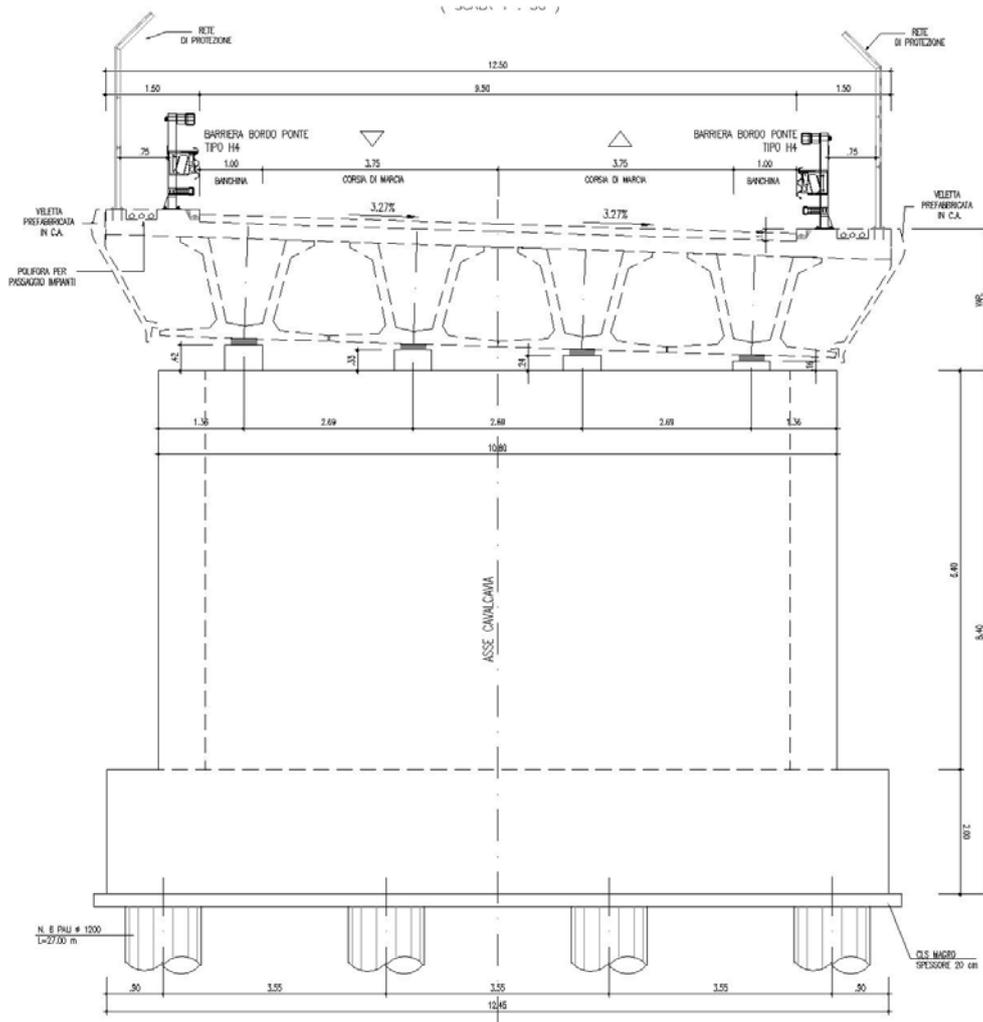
Sezione trasversale della spalla 1.
